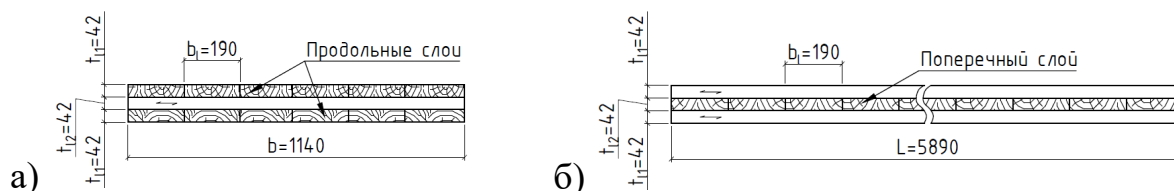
Трехслойная плита перекрытия из ДПК
